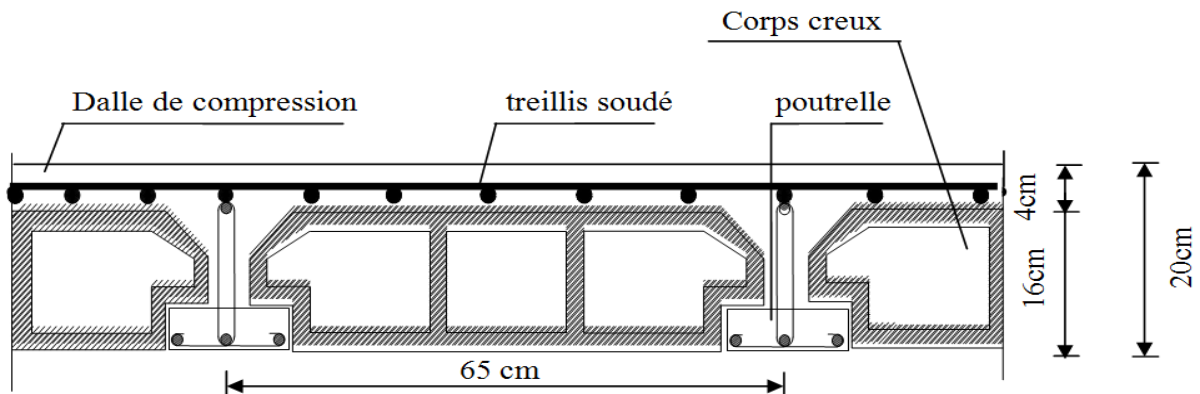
Schéma descriptif d'un plancher en corps creux
